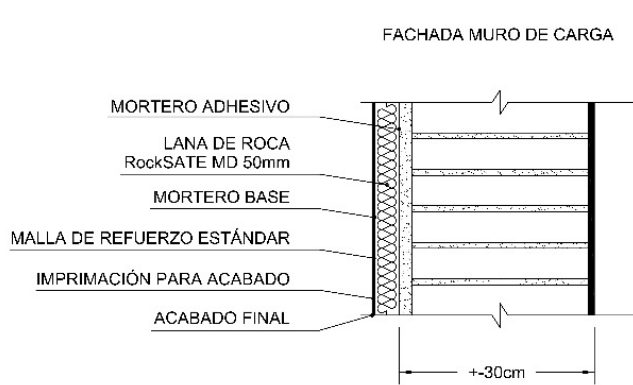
Mejora por el exterior de fachadas principales con muro de carga
